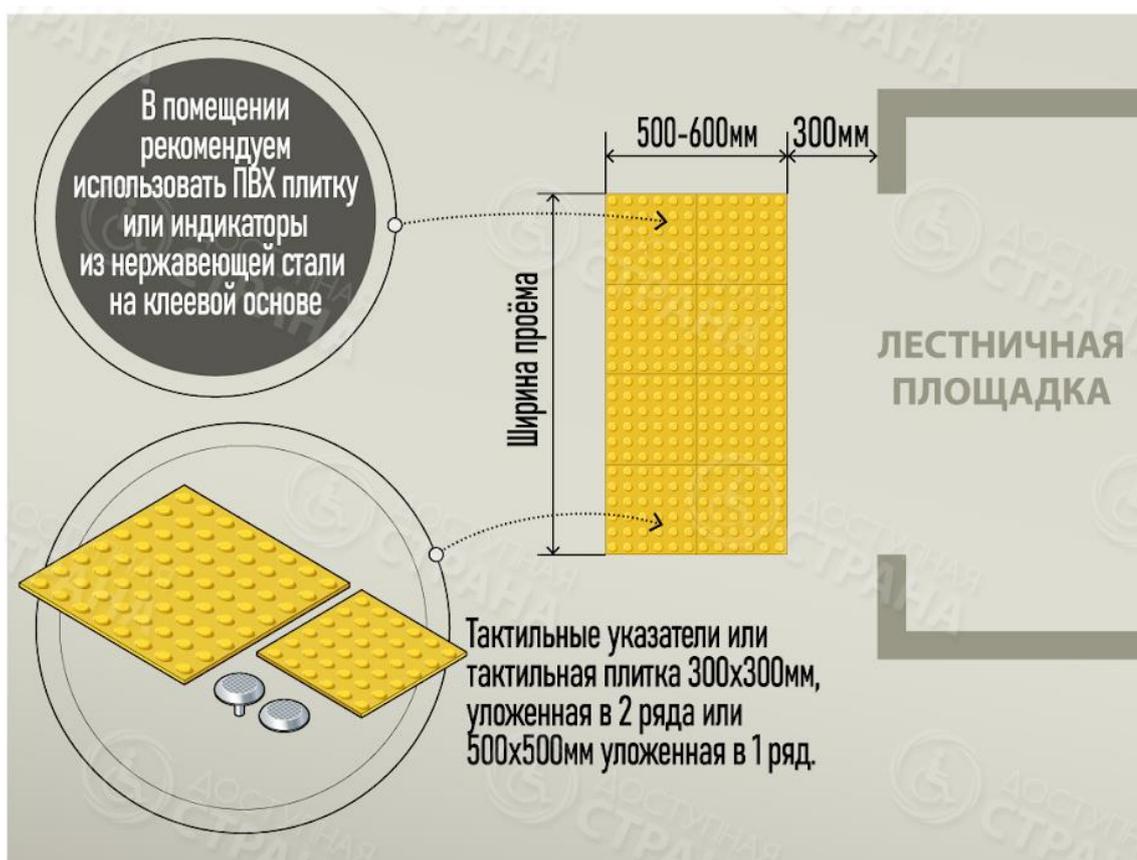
Размещение ТНУ перед открытым выходом на лестничную площадку.
